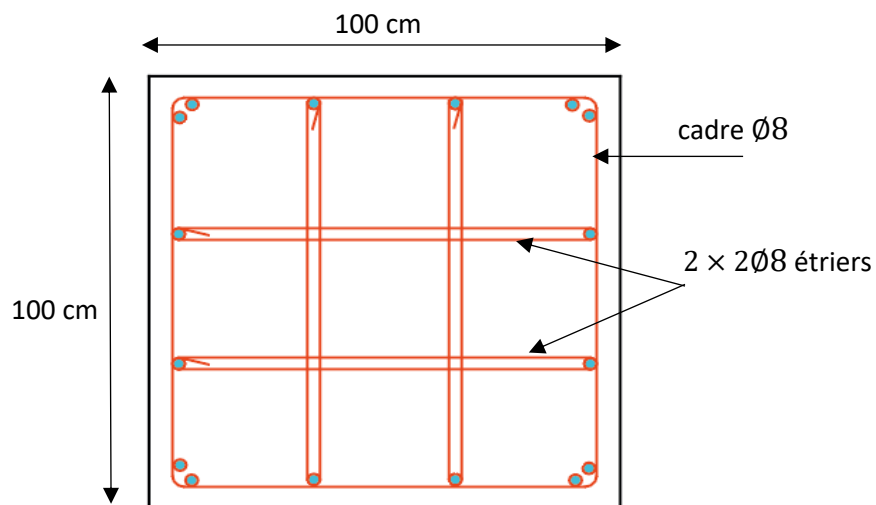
Ferrailage du fût (Vue en coupe A-A)
